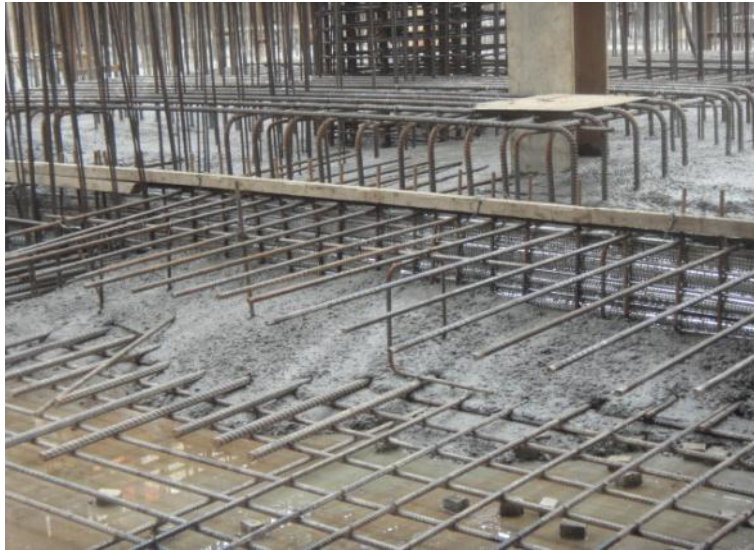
一般樓版施工縫混凝土漫流圖
